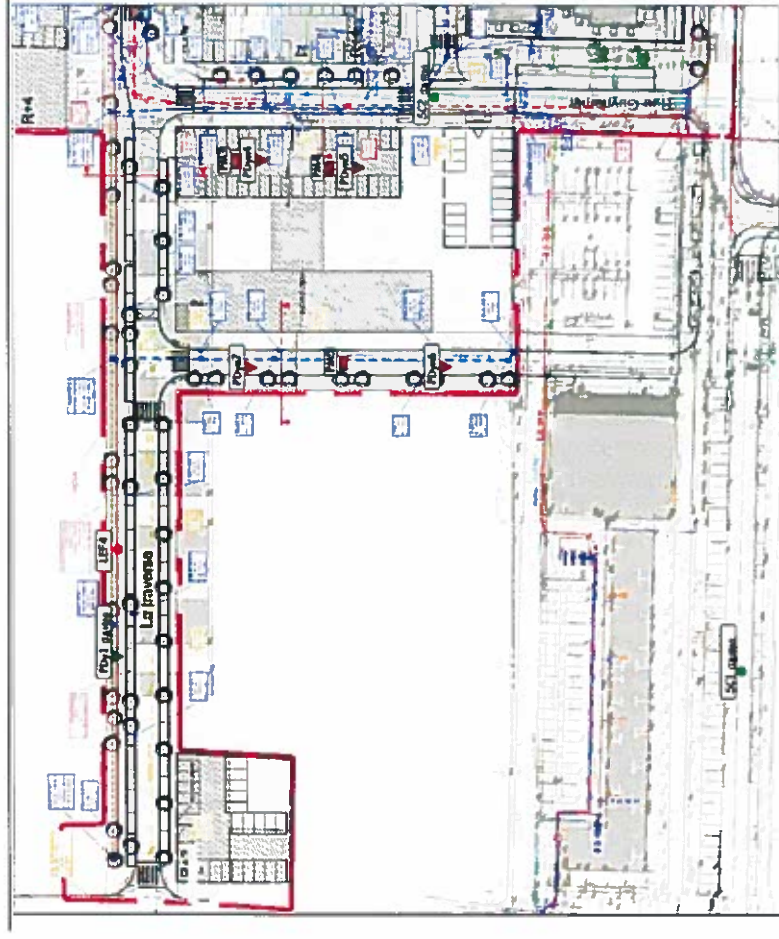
Plan d'implantation des sondages de l'étude FONDASOL d'avril 2017 - secteur Ouest
